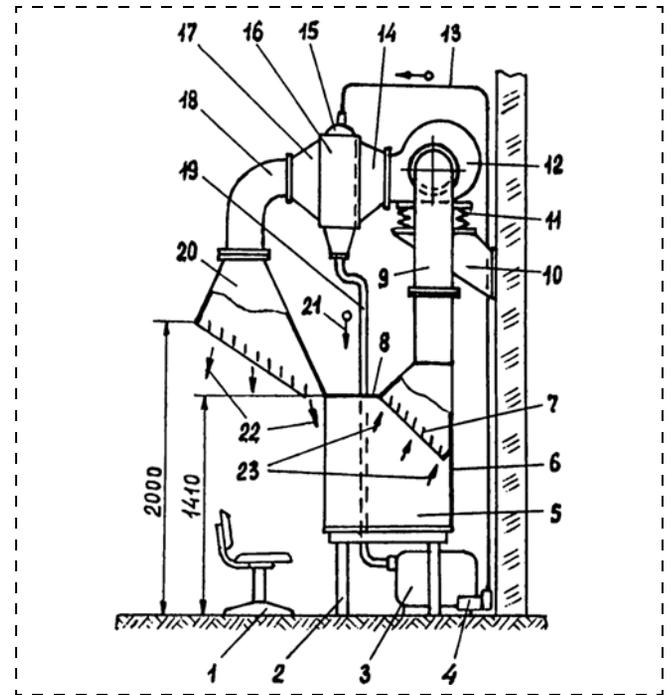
Схема агрегата душирования сварщика очищенным и охлажденным потоком воздуха системы восстановительной вентиляции:
